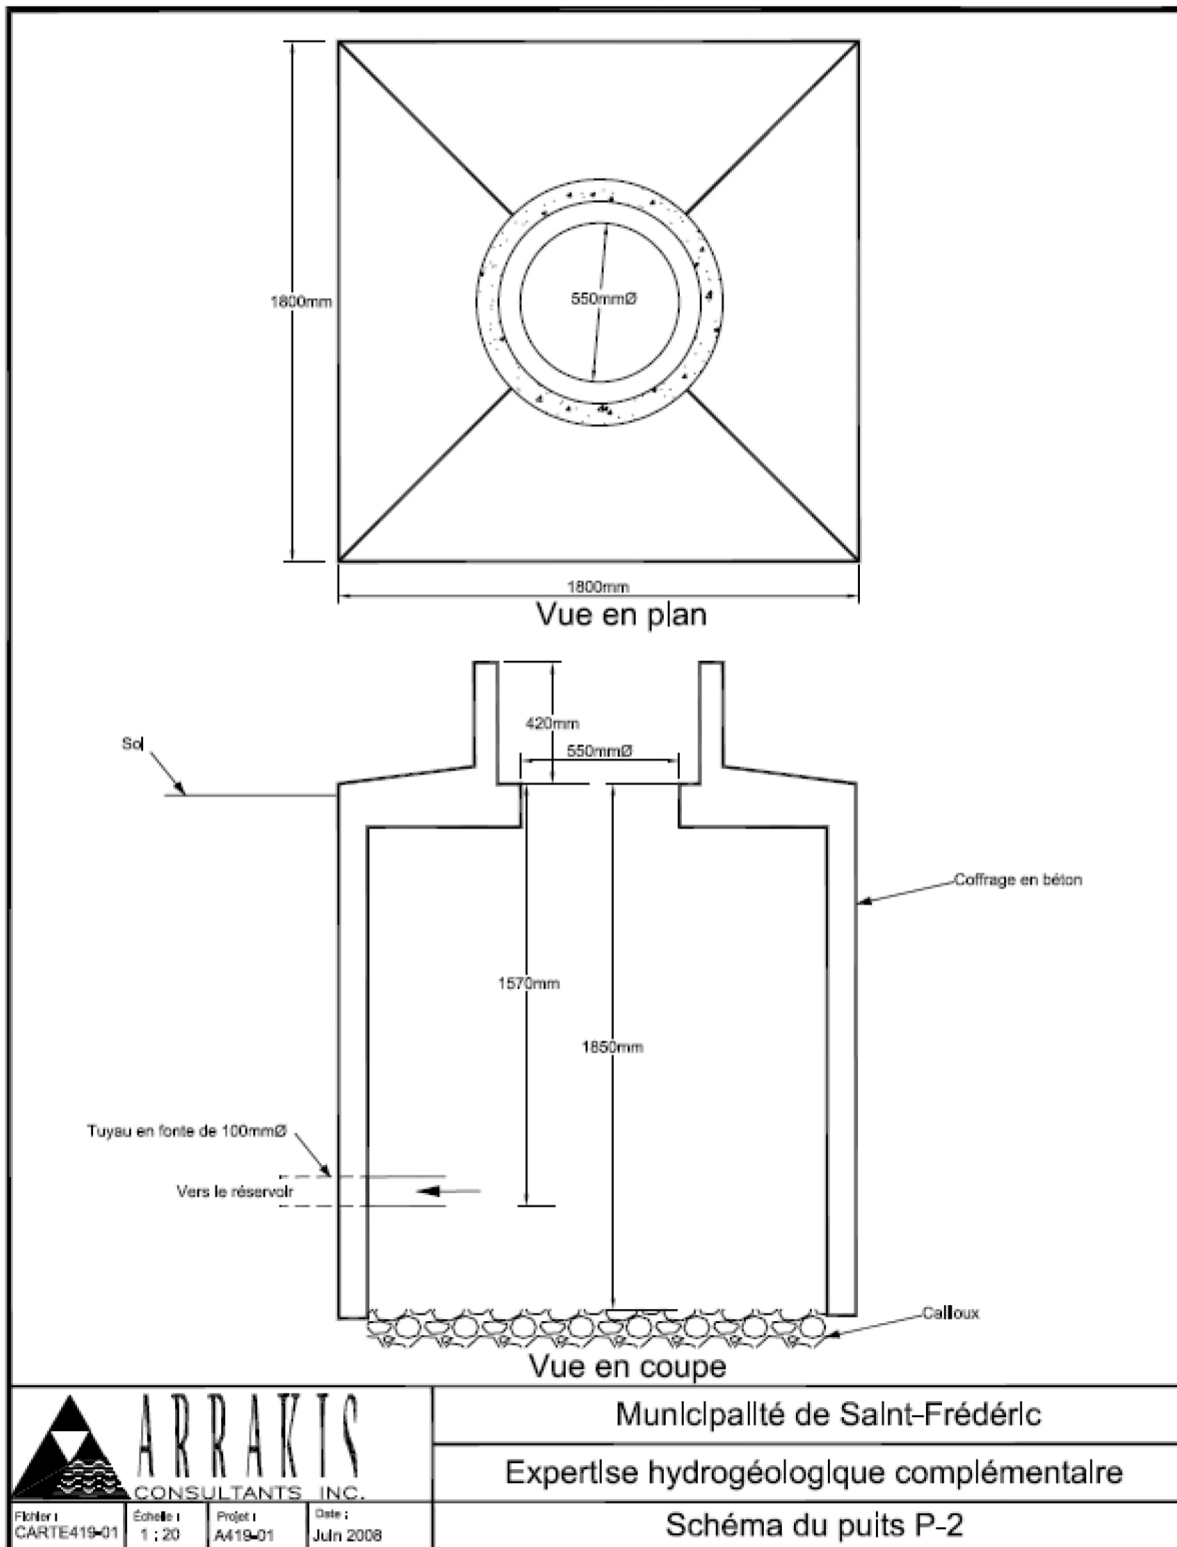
Vue en coupe de la construction de l'installation de prélèvement X2002616-3 (puits P-2)
